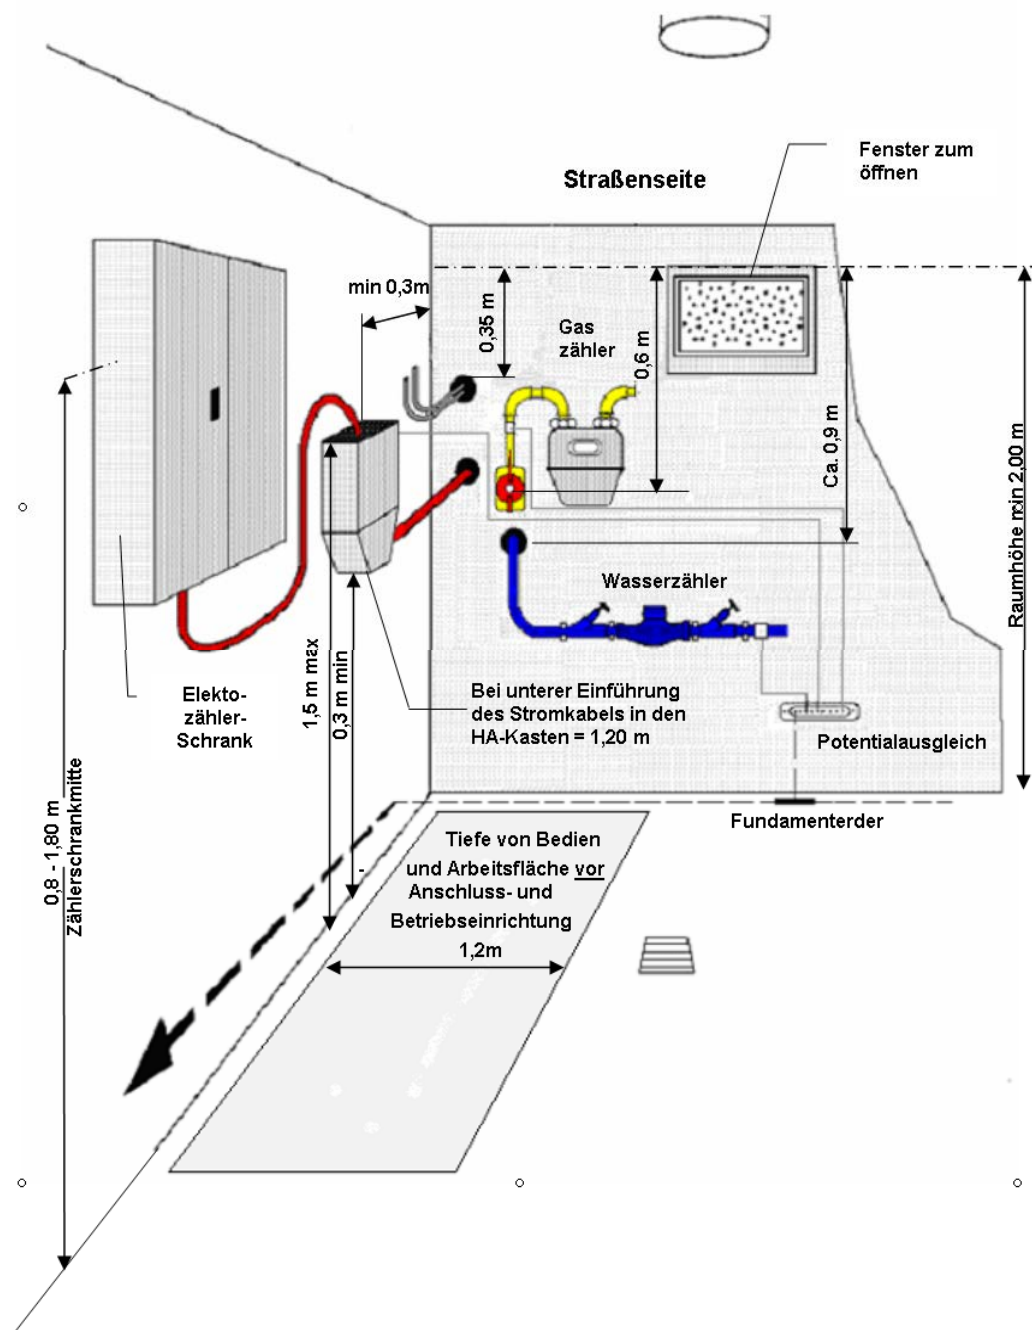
Darstellung Hausanschlussraum (Einzelspartenanschluss) mit Maßangaben
